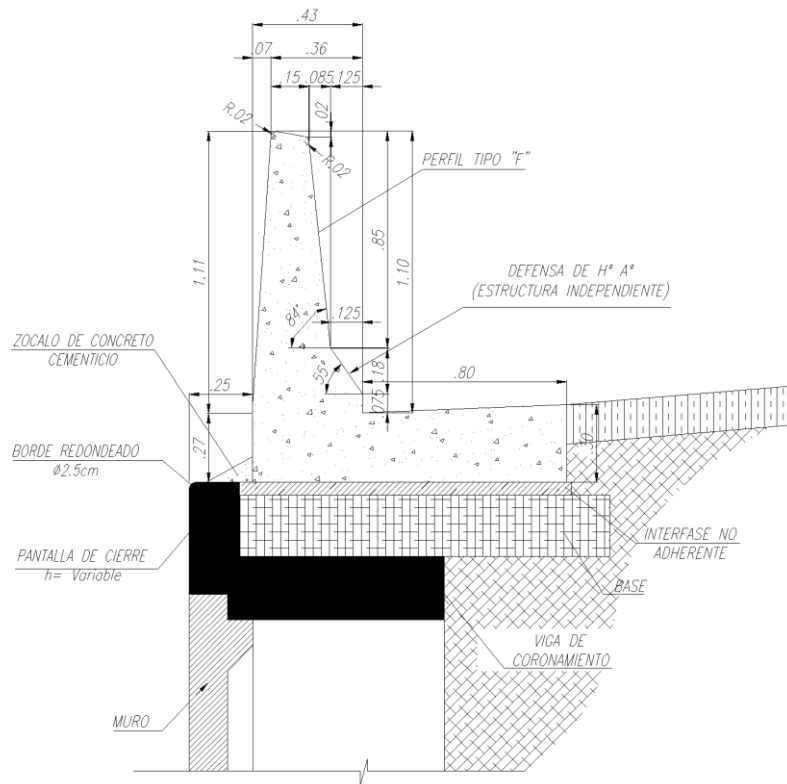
Defensa vehicular de hormigón armado. Estructura independiente
